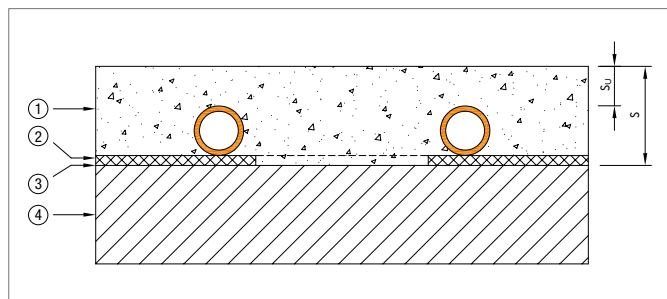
Prinzipaufbau Klettsystem RAUTHERM SPEED plus renova
